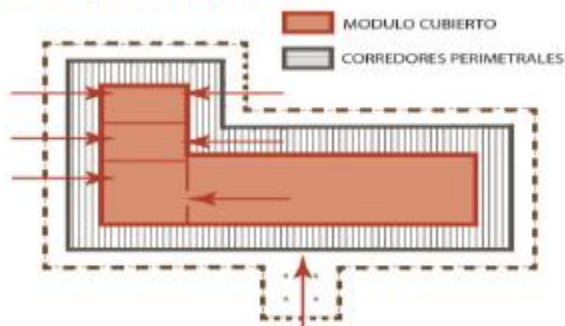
Tipología en L, corredor perimetral. Simulación de la planta arquitectónica original.
